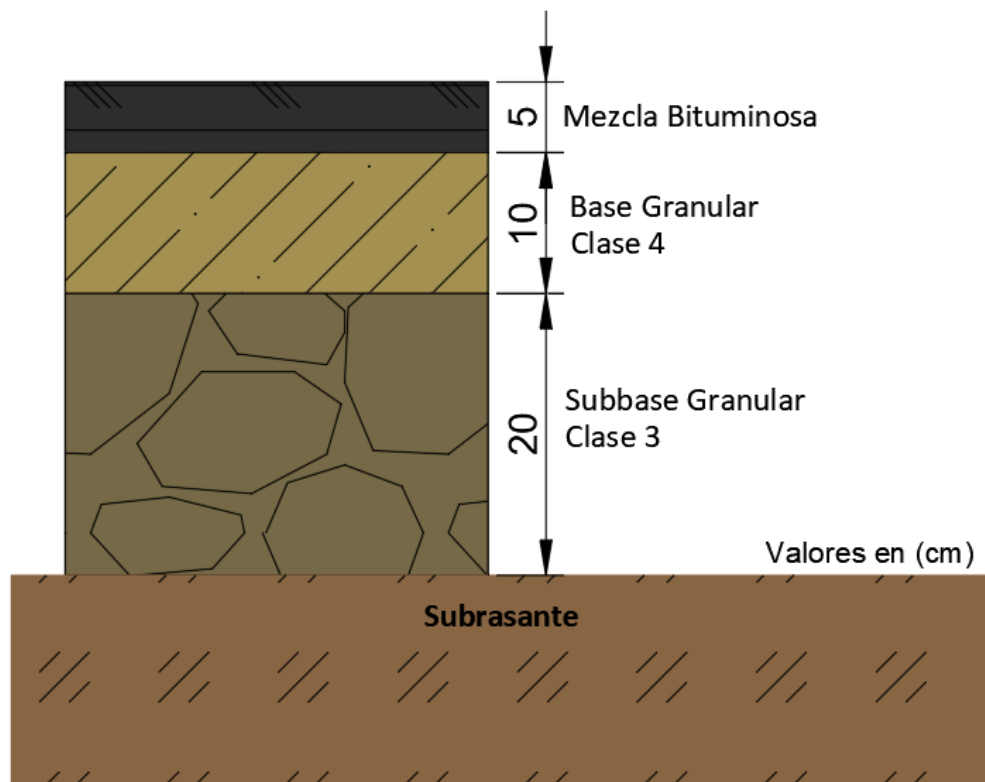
Estructura de pavimento final para las zonas sin empedrado en la vía CERCOPAMBA.
